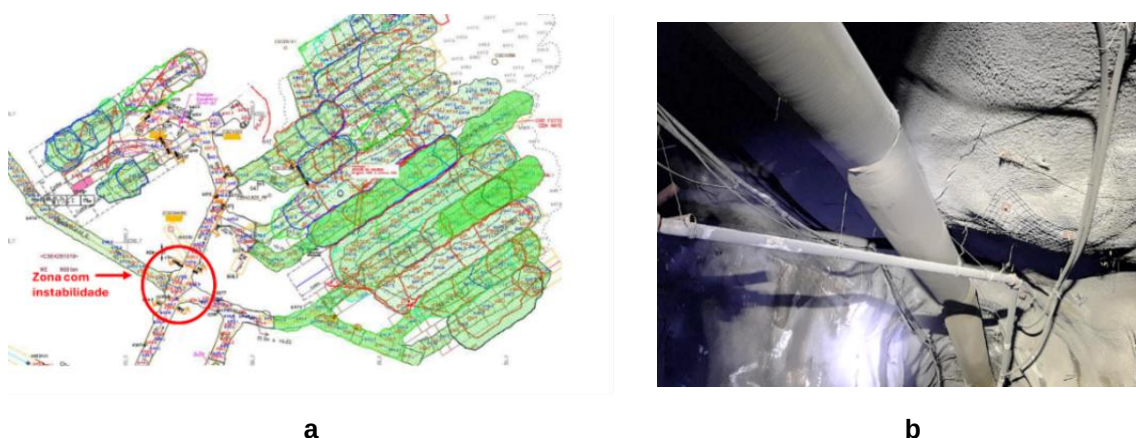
a) Carta topográfica em planta com localização da galeria de acesso a muro com pormenor da zona instável intervencionada. b) Fotografia da zona instável com pormenor das fissuras no revestimento.
